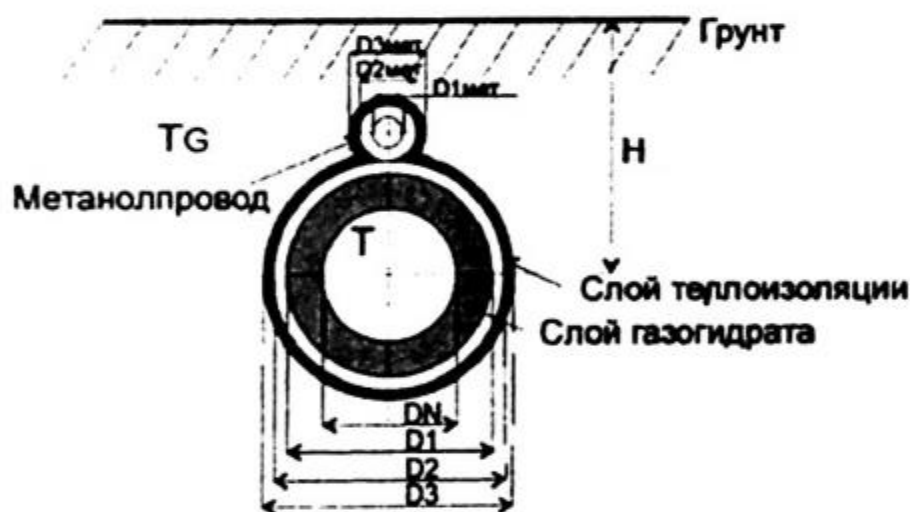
Схема прокладки трубопровода в грунте с теплоизоляцией
